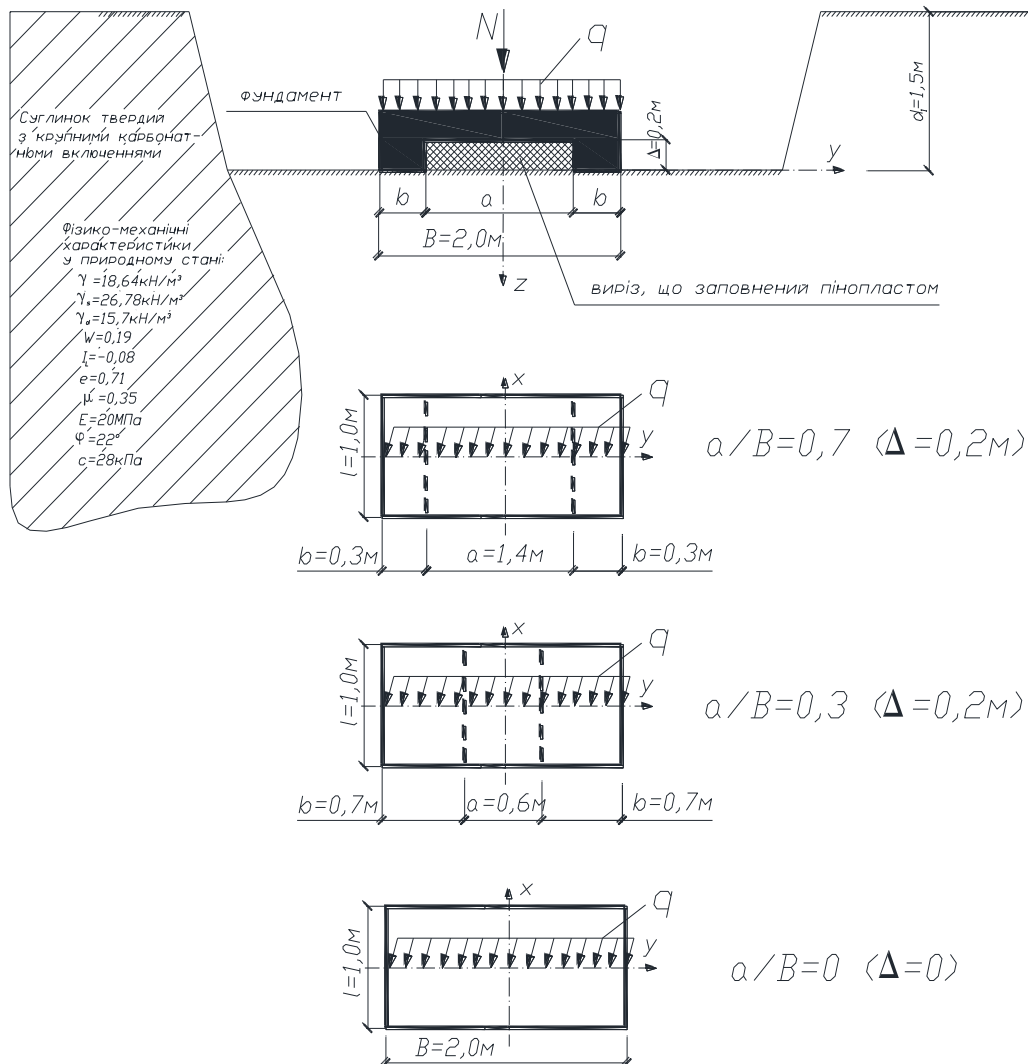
Схема взаємодії центрально навантажених фундаментів з ґрунтовою основою
